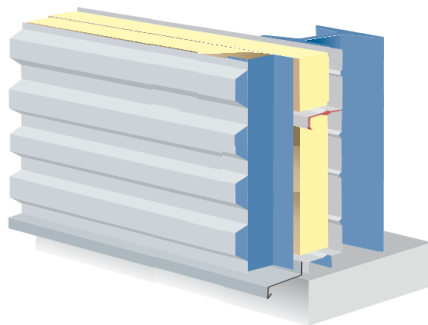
Remate de base da fachada da solução Globalwall DS [91].
